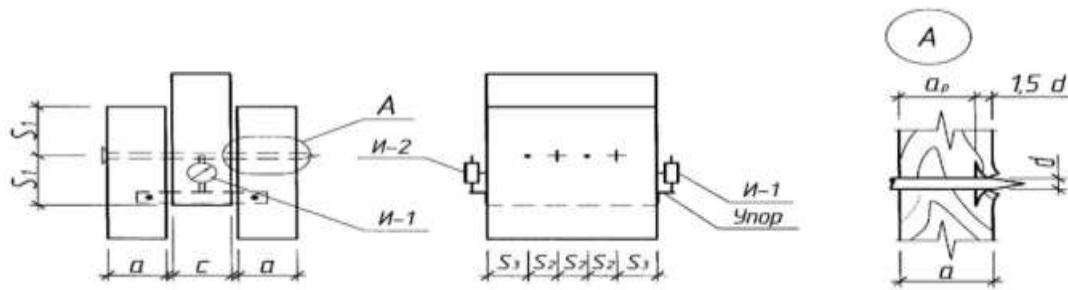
Конструкция образца гвоздевого соединения с размещением приборов
